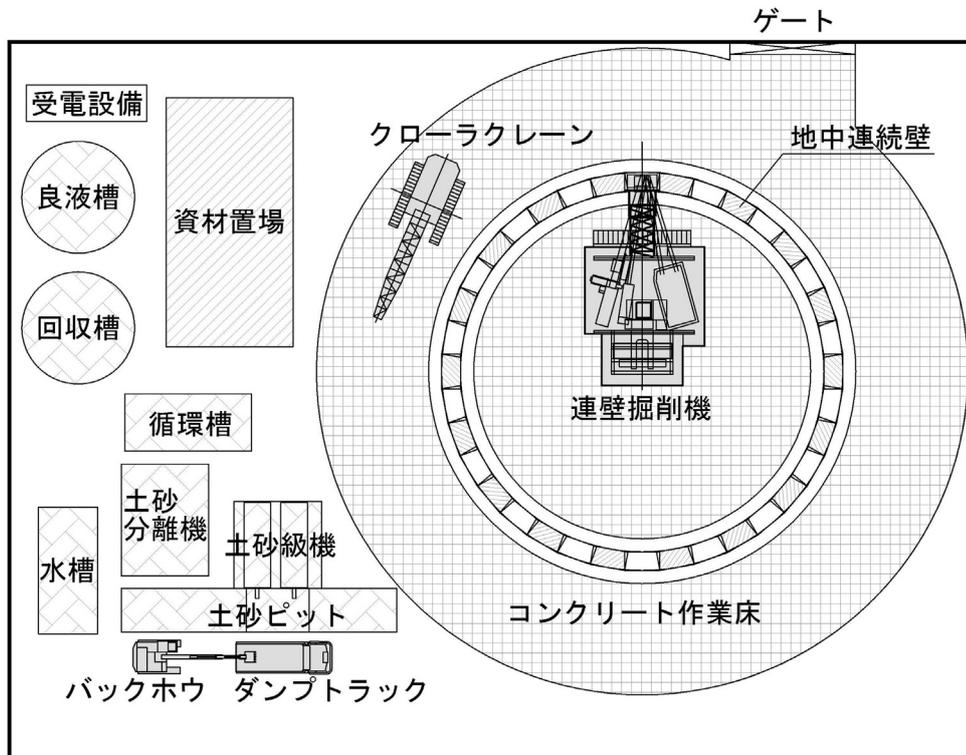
非常口の施工ヤードの概要 (RC 地中連続壁工法による非常口施工時)
